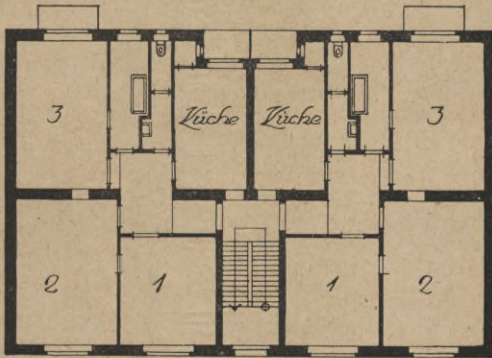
Doppelhaus mit 3-Zimmerwohnungen mit Bad.
